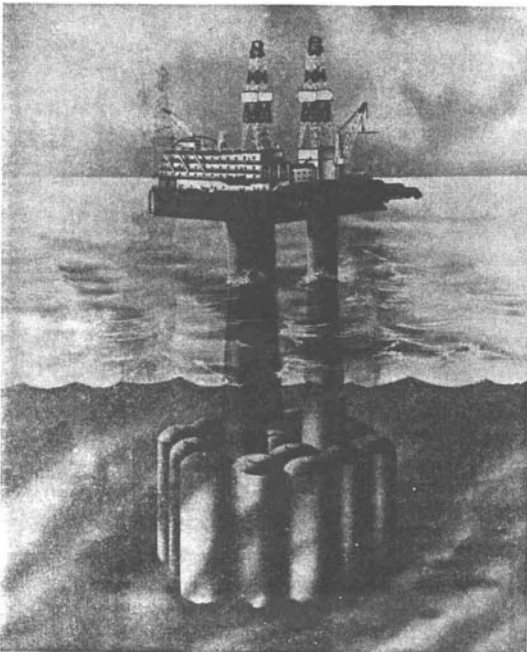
Plataforma marina. Estructura de concreto típica, base de gravedad. Fuente: *Concrete For Offshore Structures*. George C. Hoff. Durabilidad del concreto. p.471.
